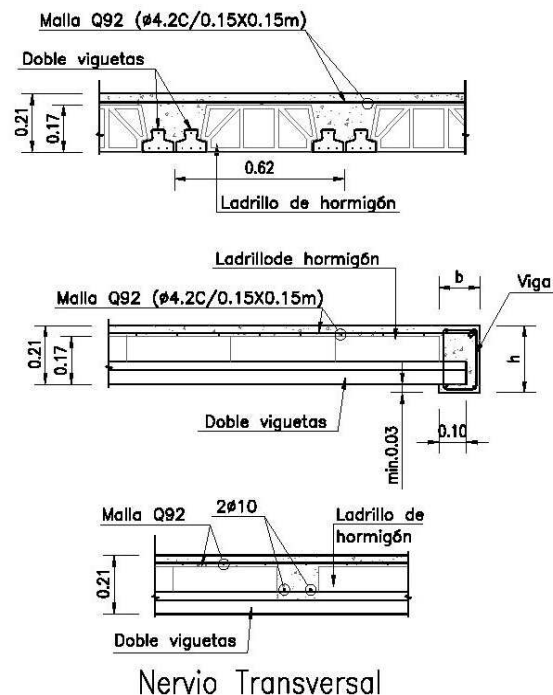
Planta de estructura y detalles de losa. Fuente: elaboración de los estudiantes
